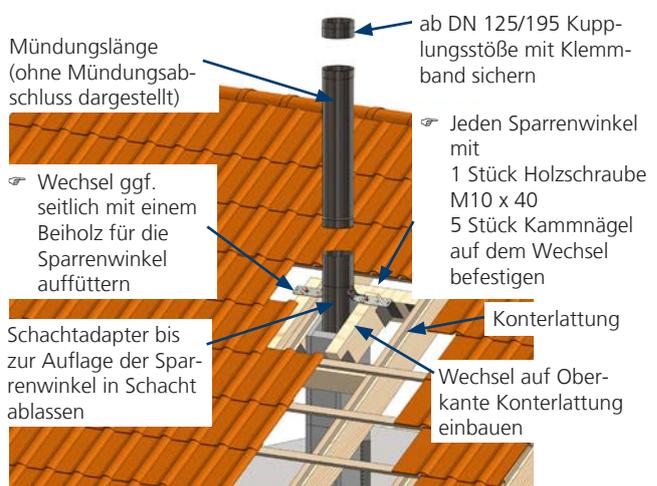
Schachtheadapter auf der Sparrenkonstruktion verschrauben
